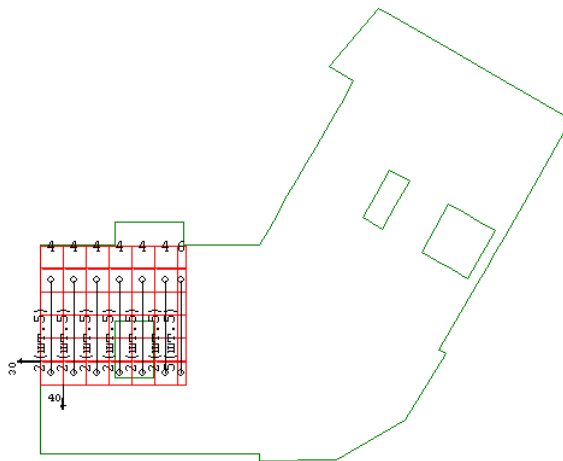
Схема раскладки сеток у верхней грани плиты, участок 2 (фрагмент)
